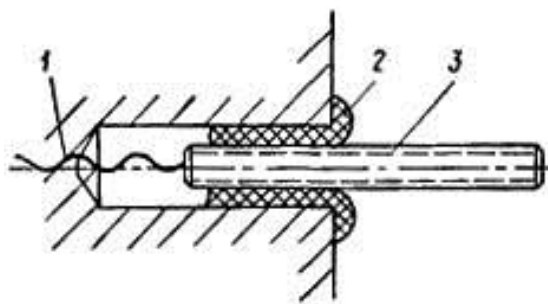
Трубчатый инъектор: 1 – трещина; 2 – обмазка эпоксидным клеем; 3 – трубка;
